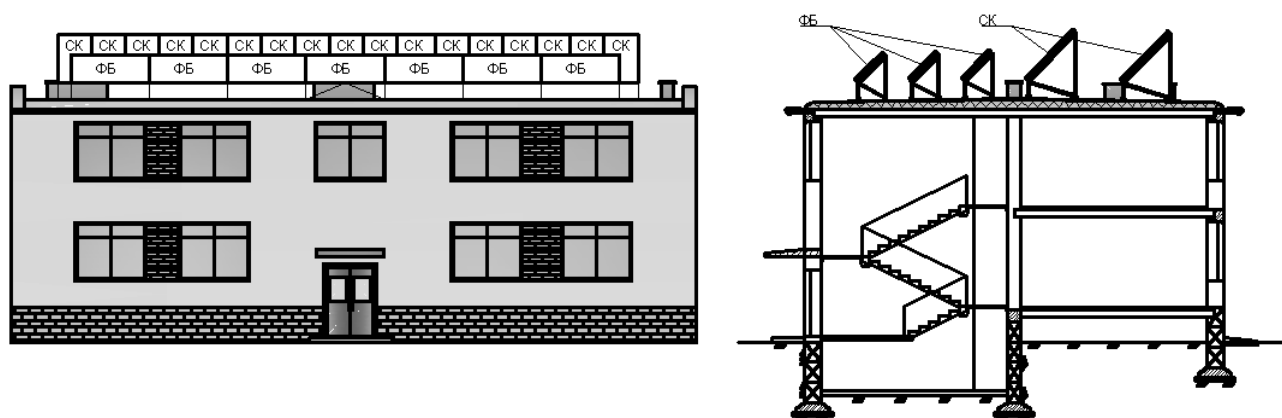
Фасад и разрез здания сервисного центра для индивидуальных отдыхающих.
